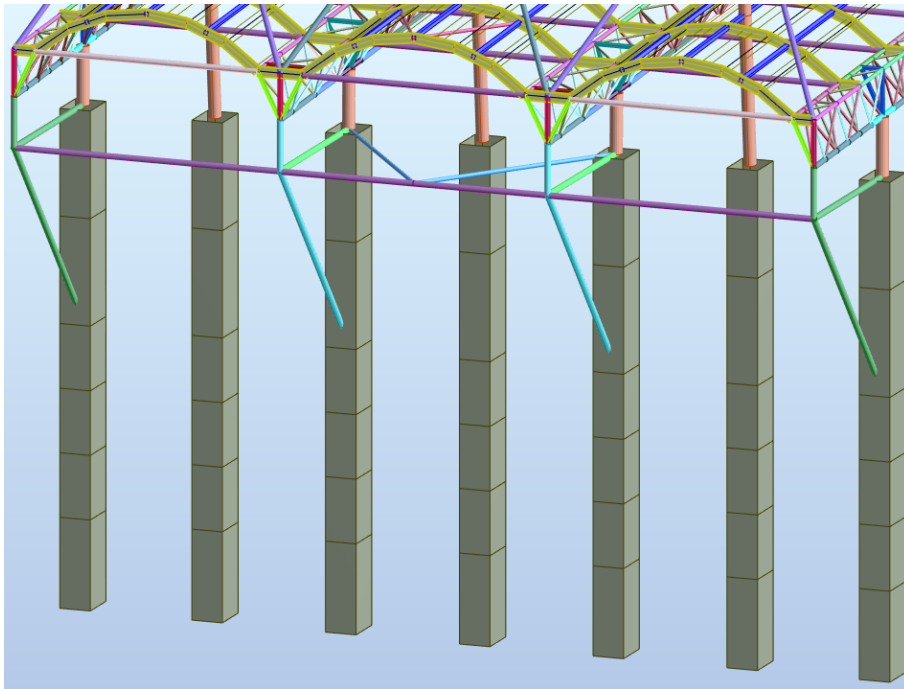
Vue 3D illustrant les poteaux verticaux supportant la toiture
